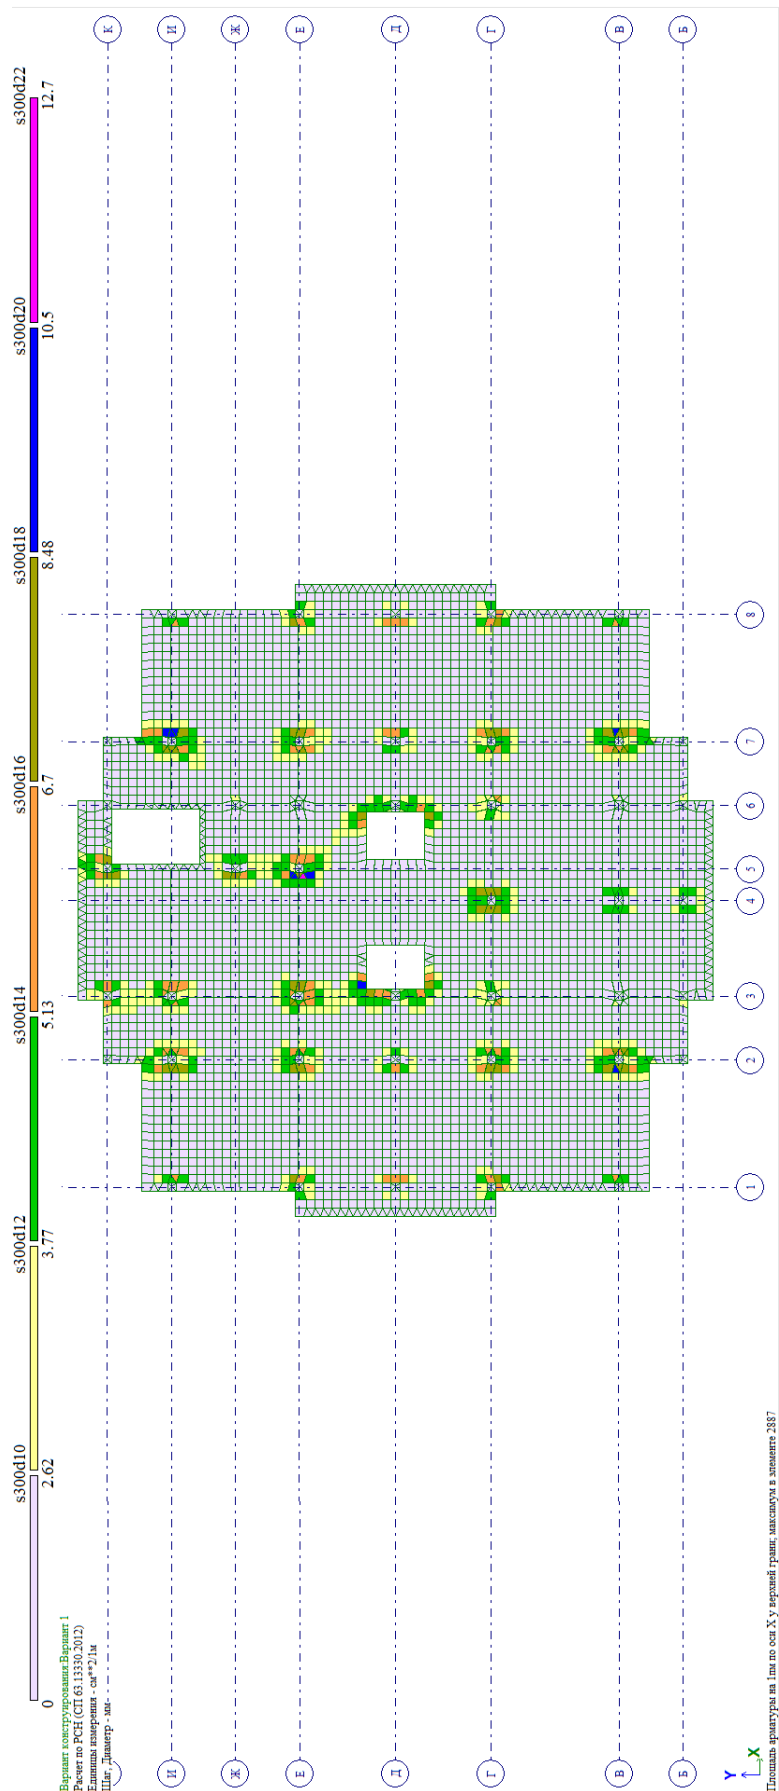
Схема подбора верхней арматуры вдоль буквенных осей (см²)
